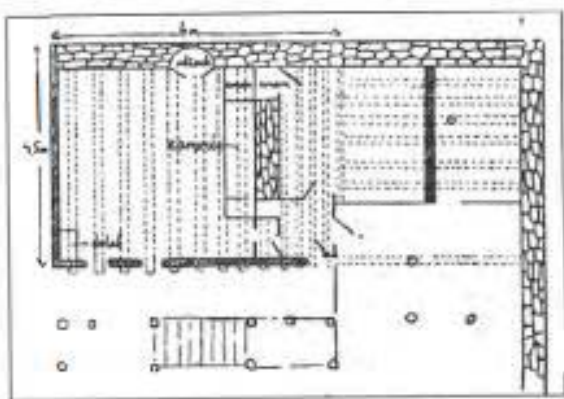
План будинку Асма-кую, 41. План нижнього поверху [11] / Fig. 8. Plan of the house Asma-kuei, 41. Plan of the lower floor [11]
